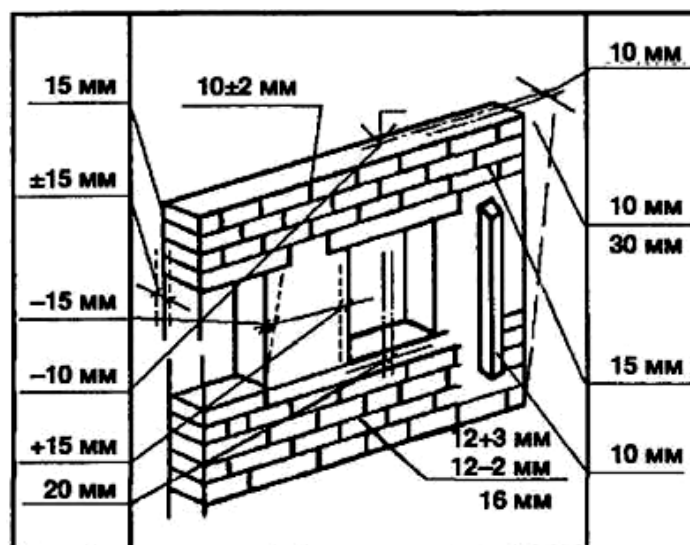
Допускаемые отклонения при кладке наружных стен
